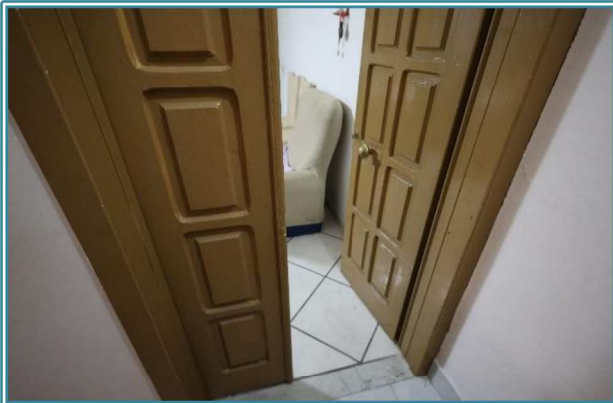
Ingresso sottotetto (Piano Secondo - Sottotetto)
